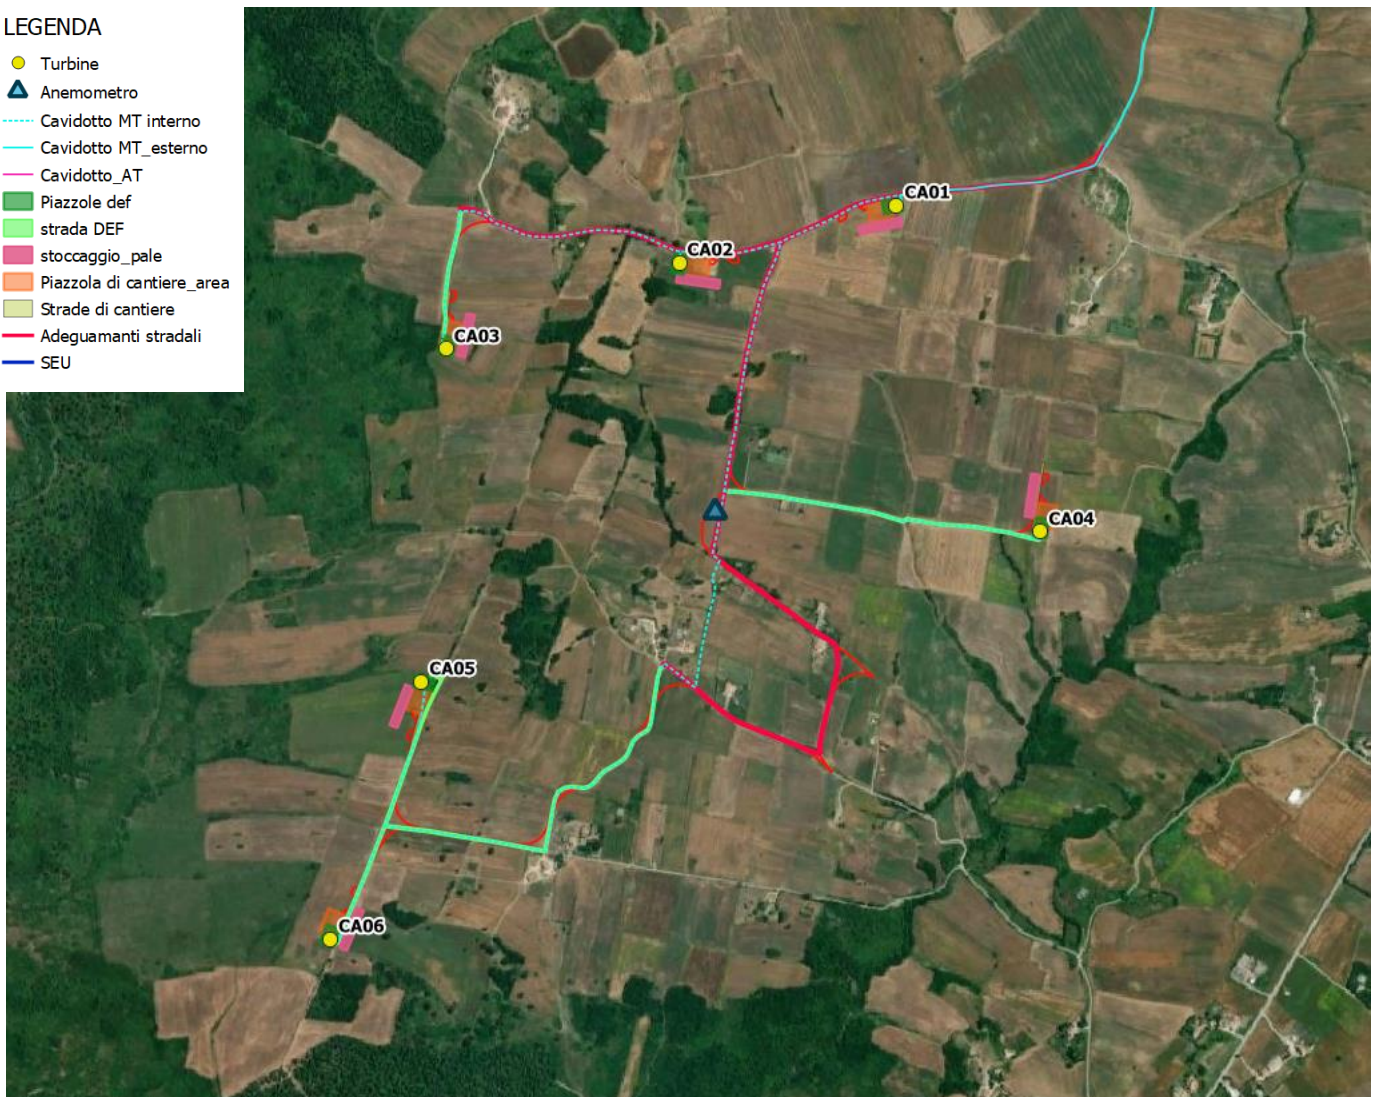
Area di sito: dettaglio layout di progetto su ortofoto
